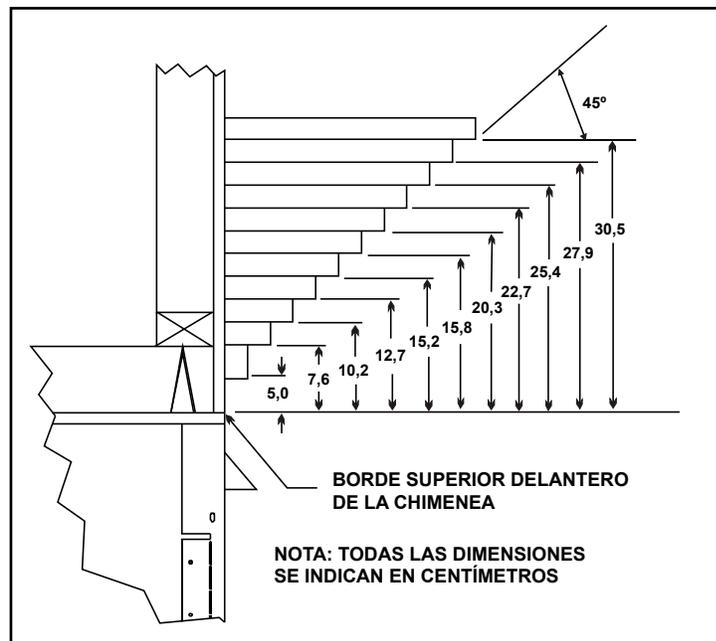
Dimensiones mínimas verticales y máximas horizontales para elementos inflamables sobre la chimenea
